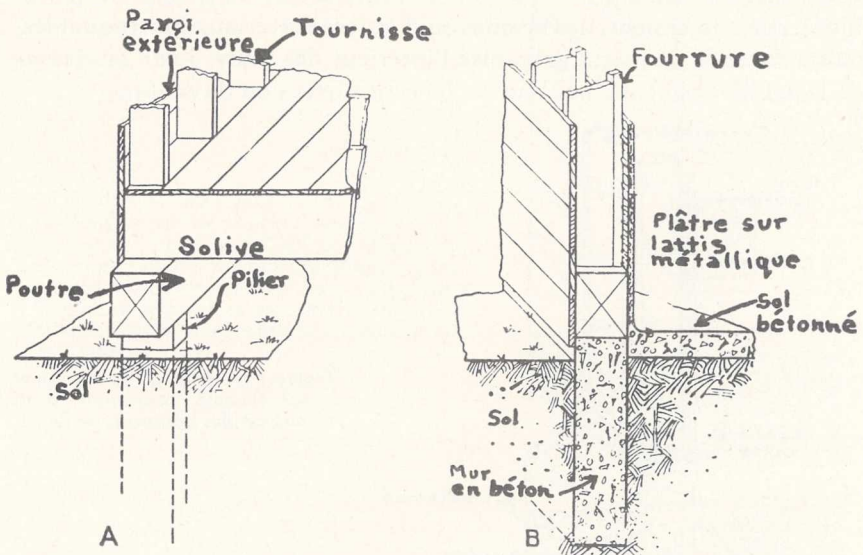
A, schéma d'une vieille grange, dont le plancher, supporté par des poutres et des piliers, n'est qu'à quelques centimètres du sol; B, la même grange rendue à l'épreuve des rats grâce à des fondations et un plancher en béton et des murs revêtus d'une couche de ciment.
